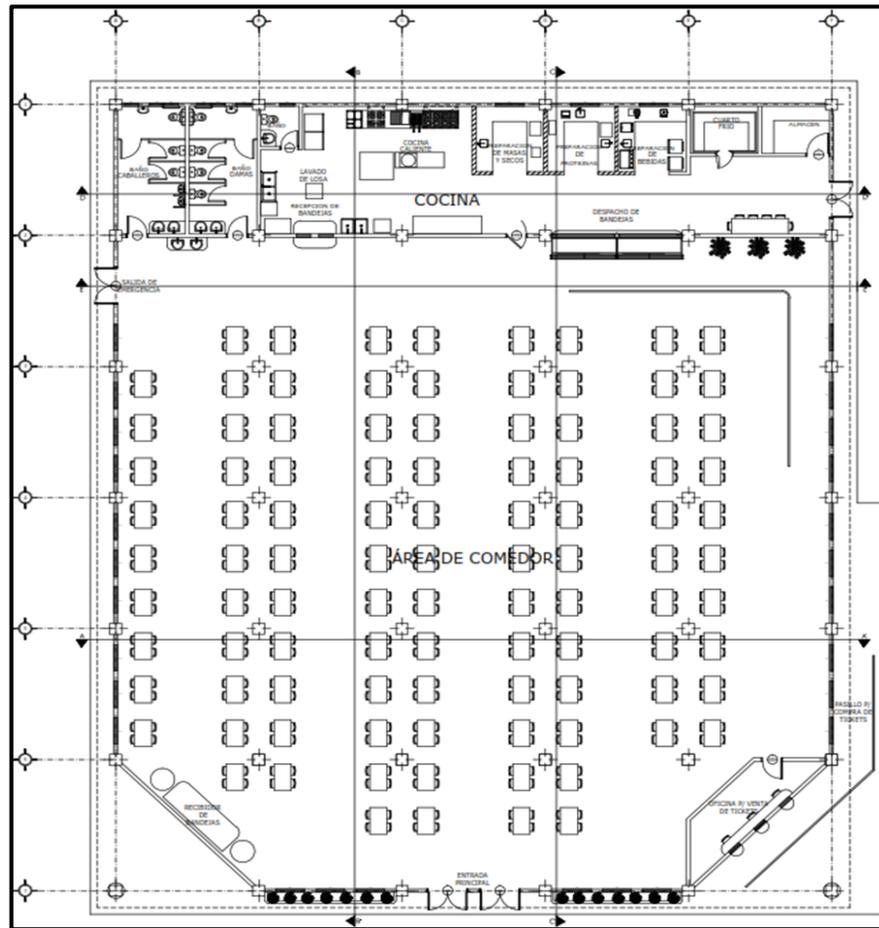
Plano de planta propuesto del proyecto del comedor universitario.
